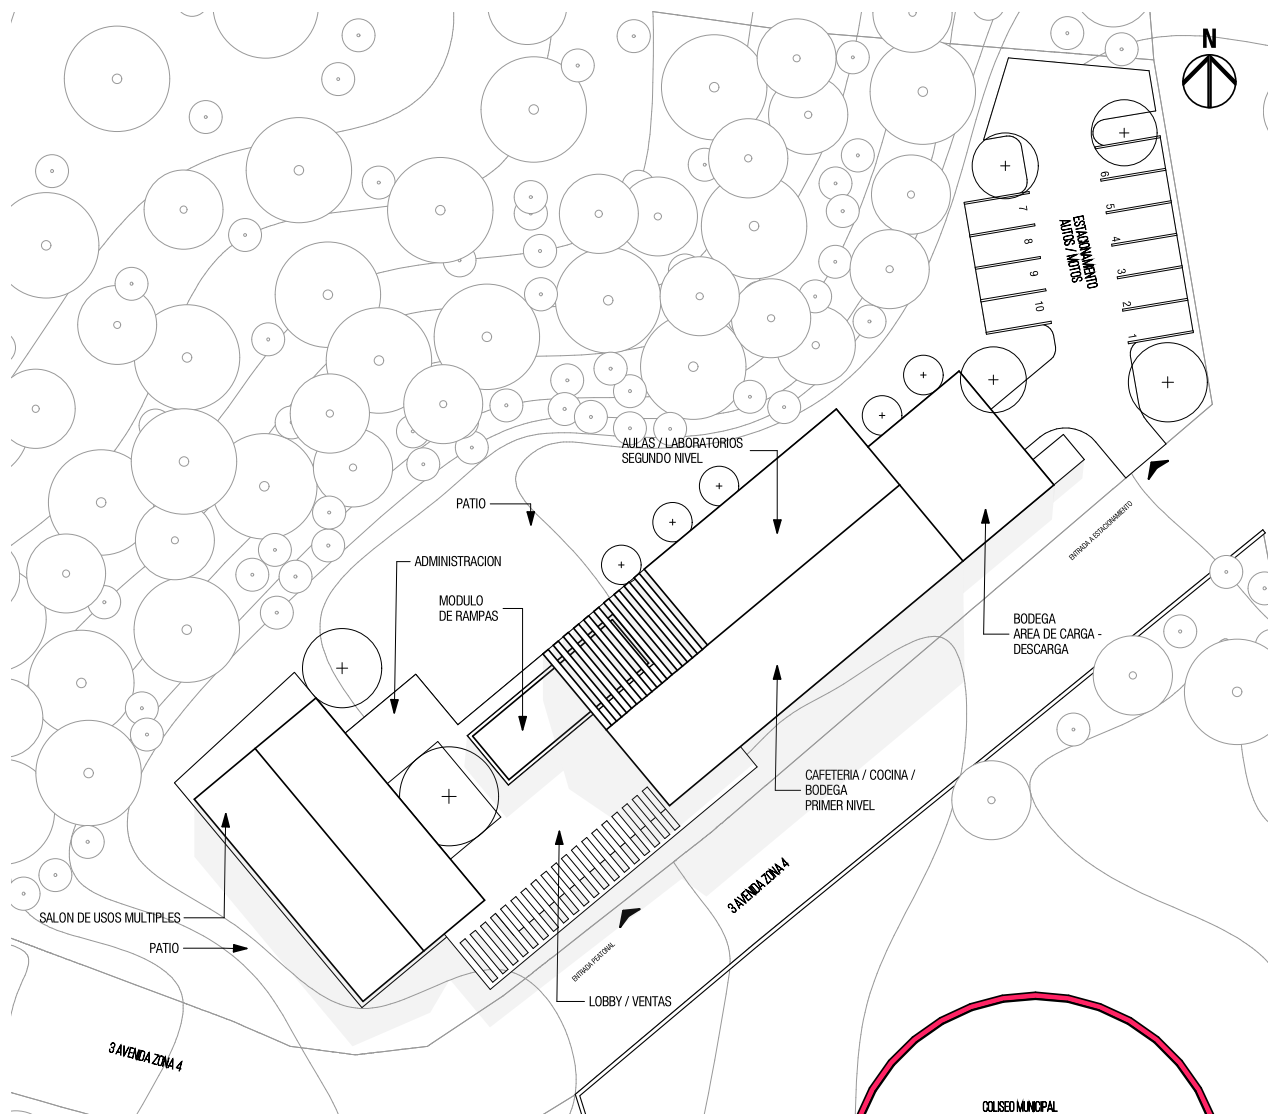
Geometrización e Implantación, vista de Planta, Elaboración Propia.
